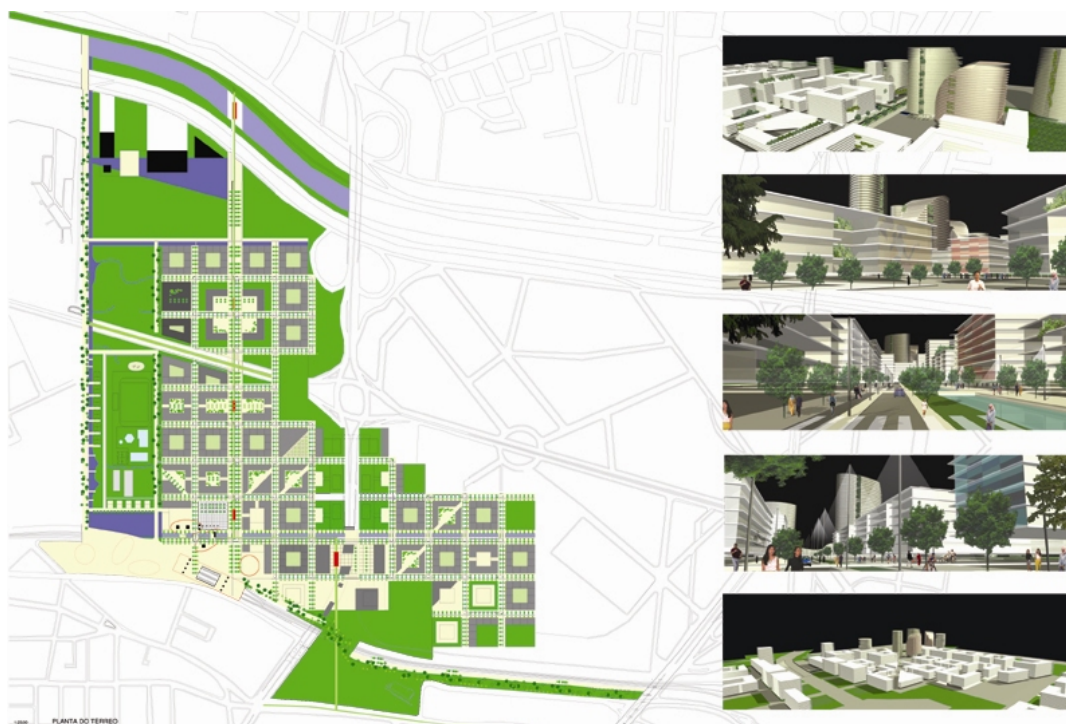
Proposta final destacando a planta do terreno e as vistas aéreas e da escala do pedestre.
